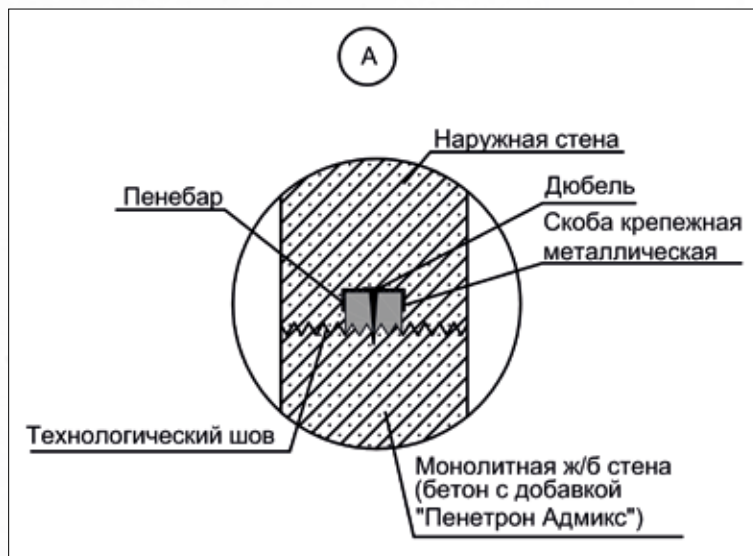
Гидроизоляция шва бетонирования (технологического шва) в наружной стене
